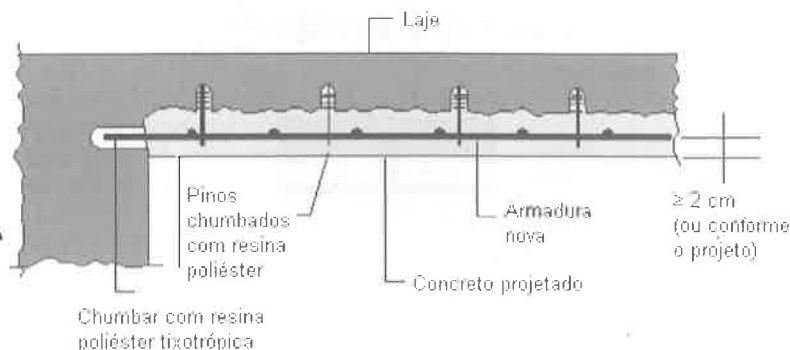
Reforço de flexão em lajes com concreto projetado.
